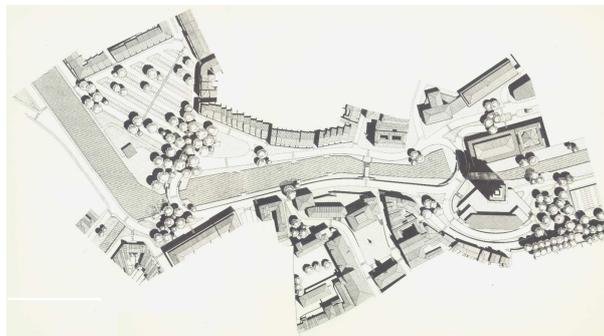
Estudo prévio do arranjo urbanístico e arquitectónico da zona central de Aveiro (existente) pl. 68 | Plano Director da Cidade de Aveiro, 1964
